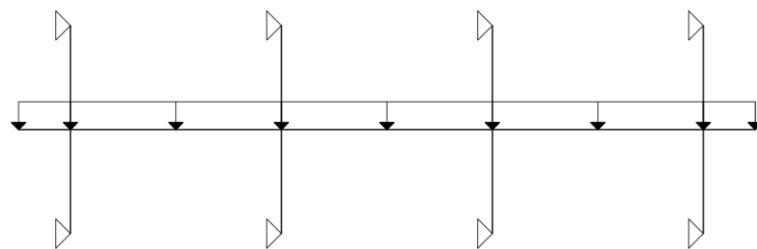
Pórtico equivalente considerando os pilares em seus trechos superior e inferior ao pavimento.
